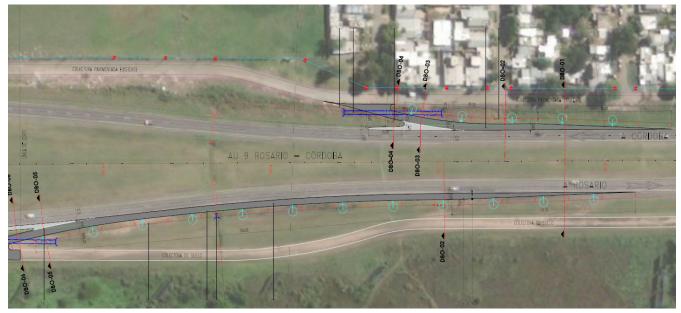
Planimetría Ramas de entrada y salida, Intersección RN № 0009 y Boulevard Wilde Km 298,50
